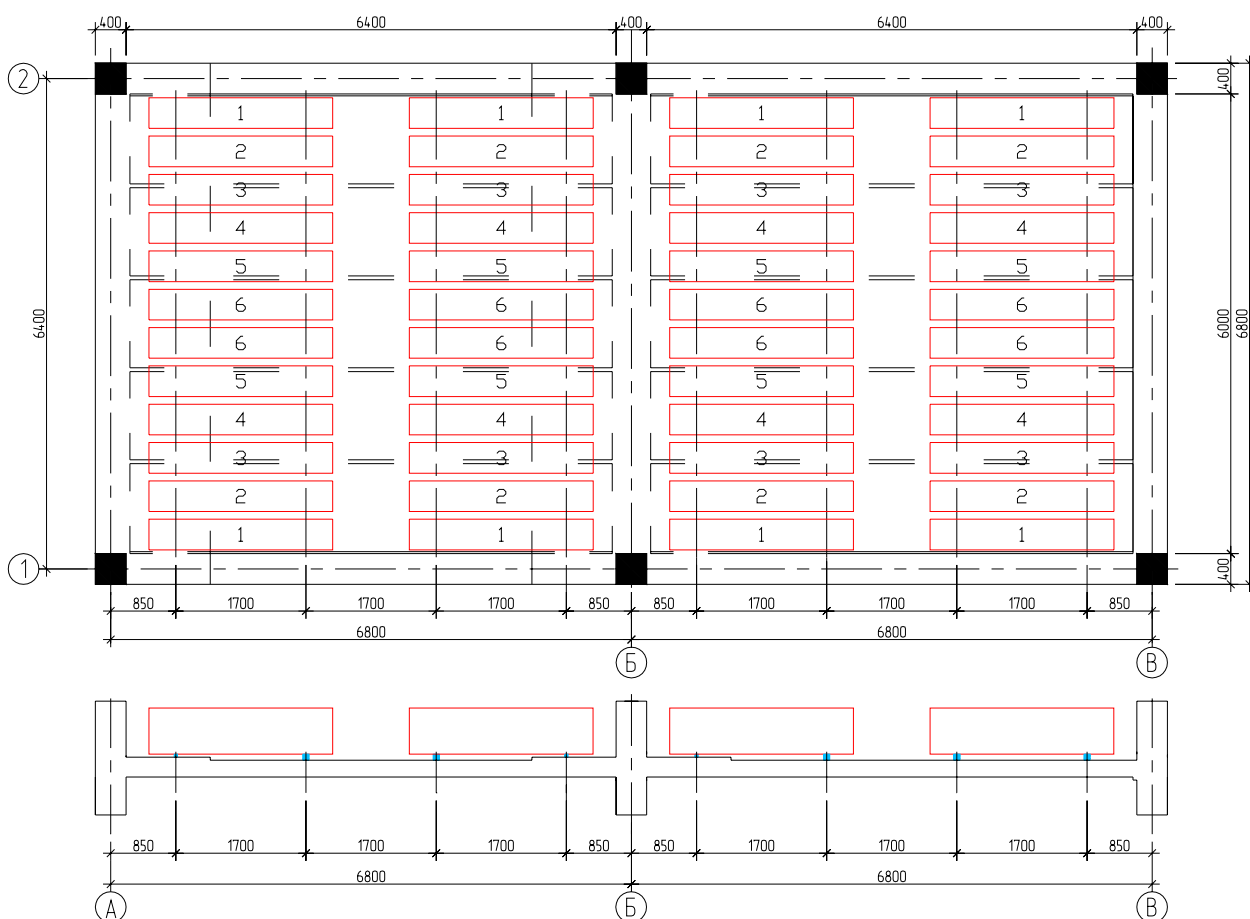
Схема раскладки блоков ФБС на перекрытие фрагмента. Цифры на блоках означают ступени нагружения.
